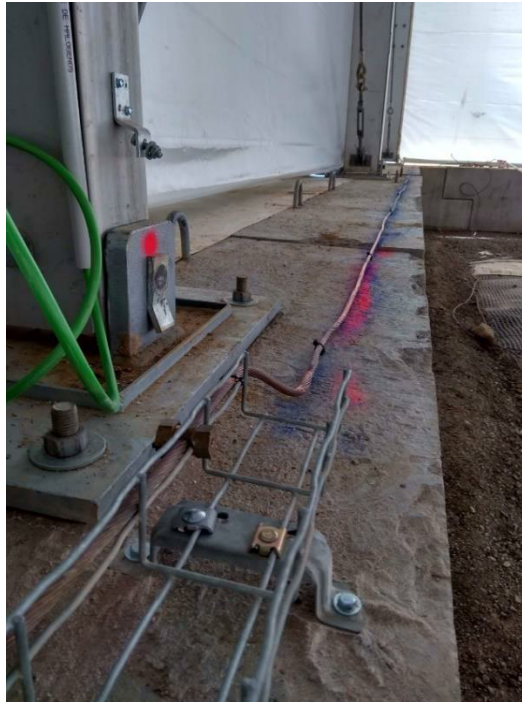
Tramo fijado a la bandeja y tramo fijado a la zapata de hormigón
